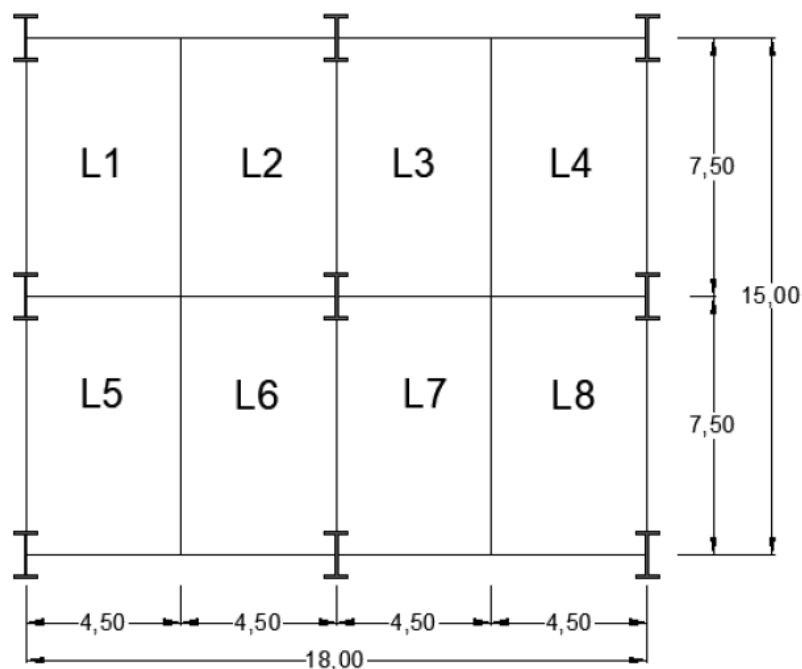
Esquema estrutural do caso 1 para as estruturas A e B (Fonte: Sandes, 2019)
